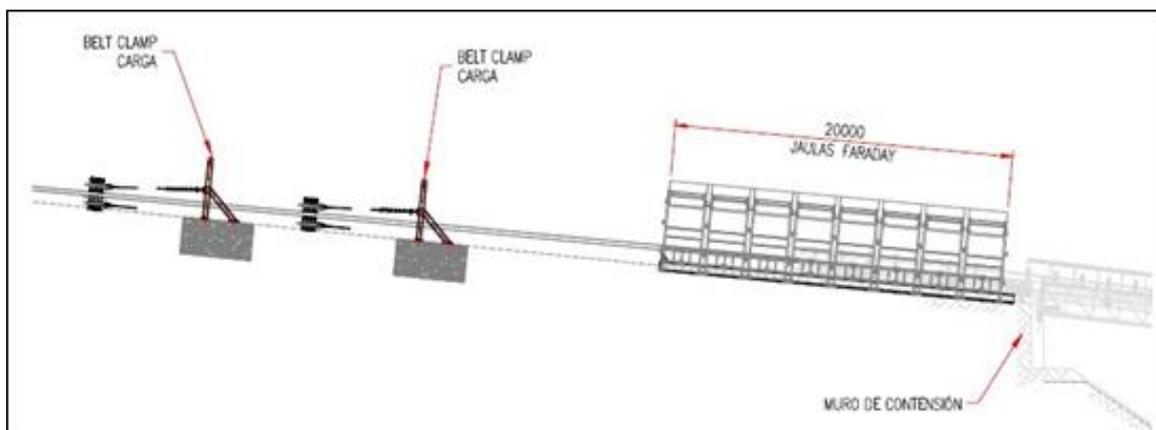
Vista de Sección / Esquema de Ubicación / Empalme de Cierre
